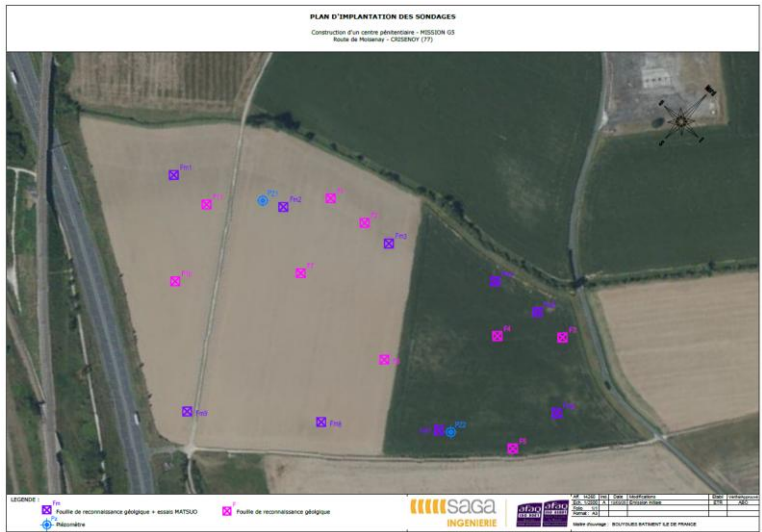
Plan des sondages (Source : SAGA INGENIERIE)
